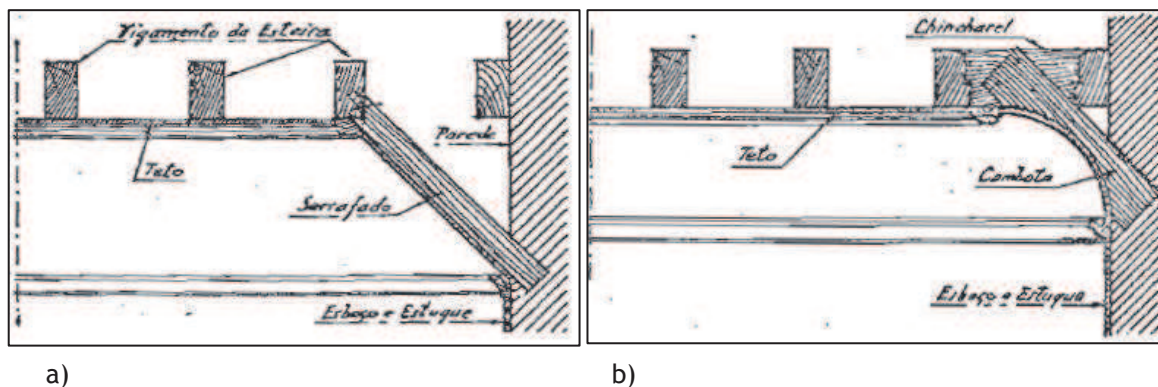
Cortes de pormenor: a) teto de masseira; b) teto sanqueado [Costa, 1955].
